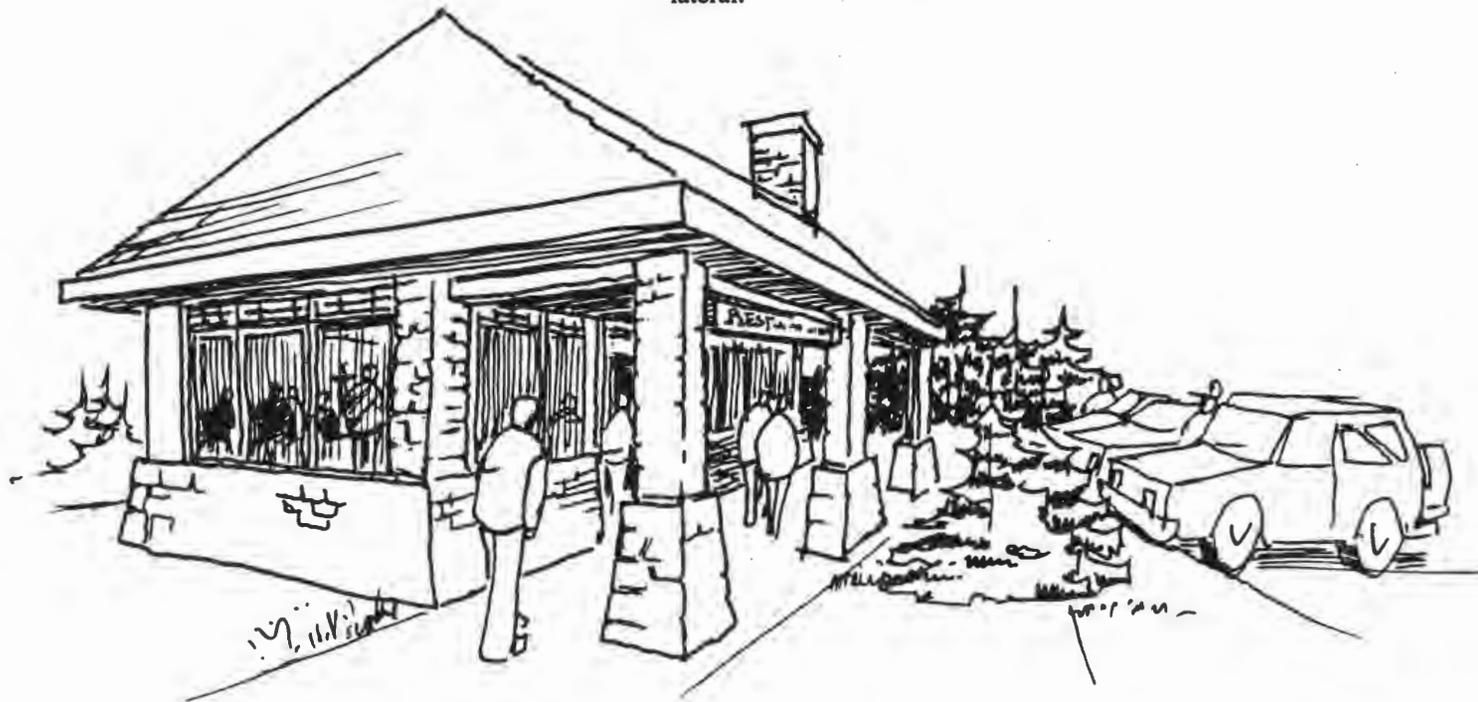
Les mêmes matériaux de finition seront utilisés sur toutes les façades apparentes.
